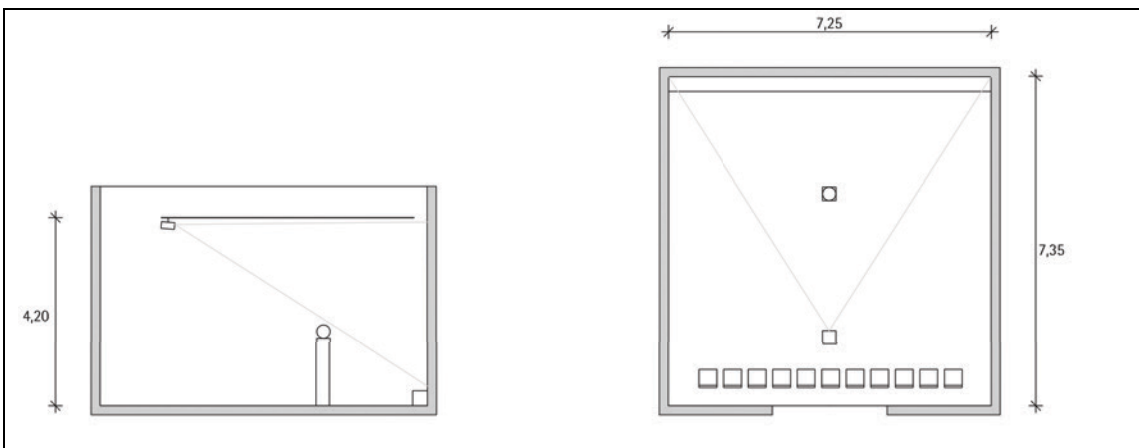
Schnitt und Grundriss des neutralen Innenraumes
